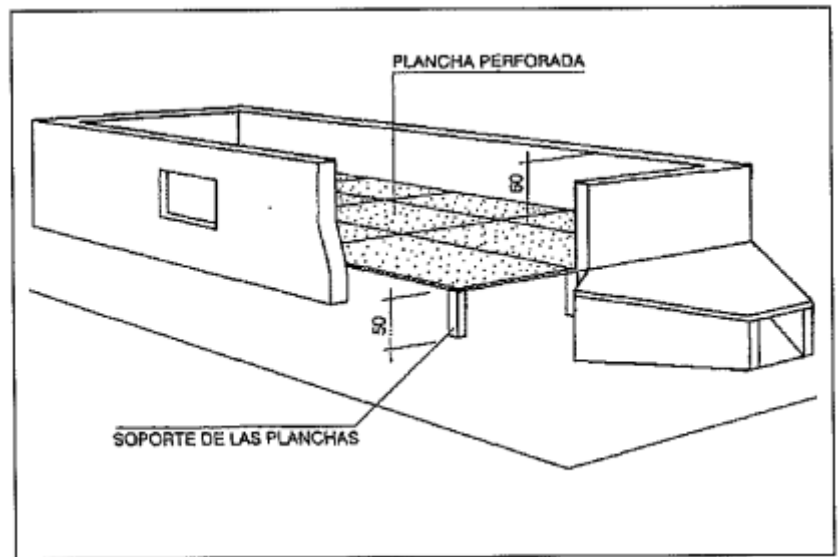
Cámara de secado y cámara de distribución de aire en el secador de lecho fijo.
